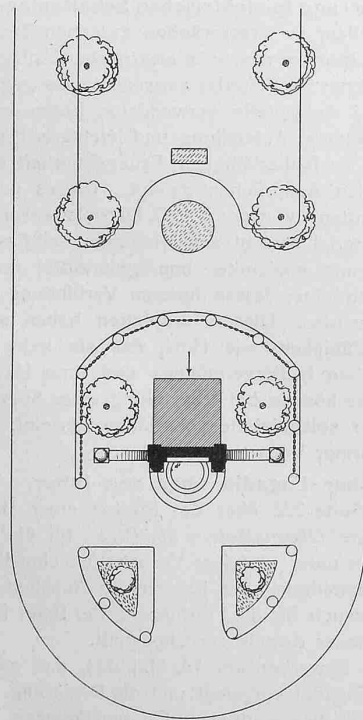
Lageplan der ergänzten Brunnenanlage. — 1 : 300.
